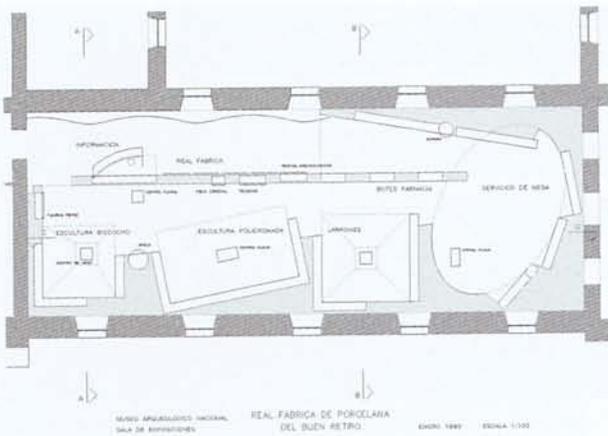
Planimetría de la exposición Manufacturas del Buen Retiro (1780-1808).
